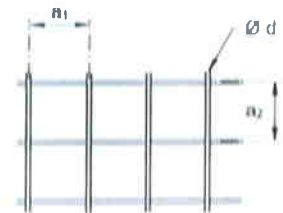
Geschweisste Bewehrungsmatte
